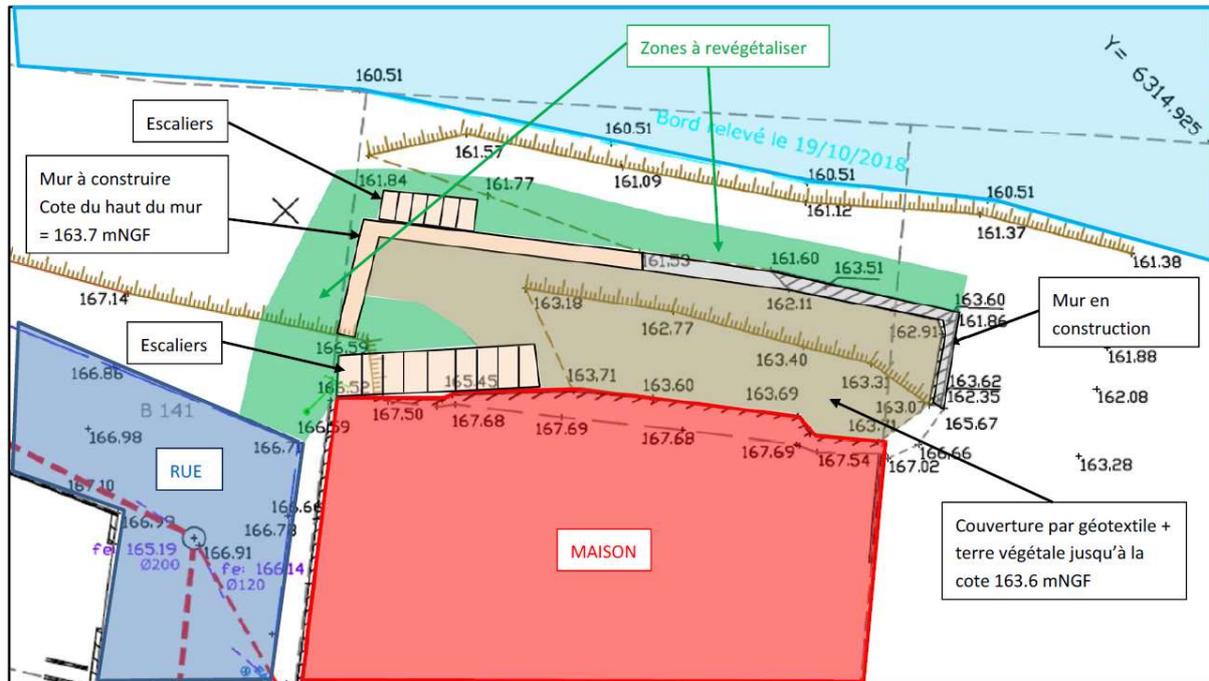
Implantation de principe du mur à construire – La Papèterie
